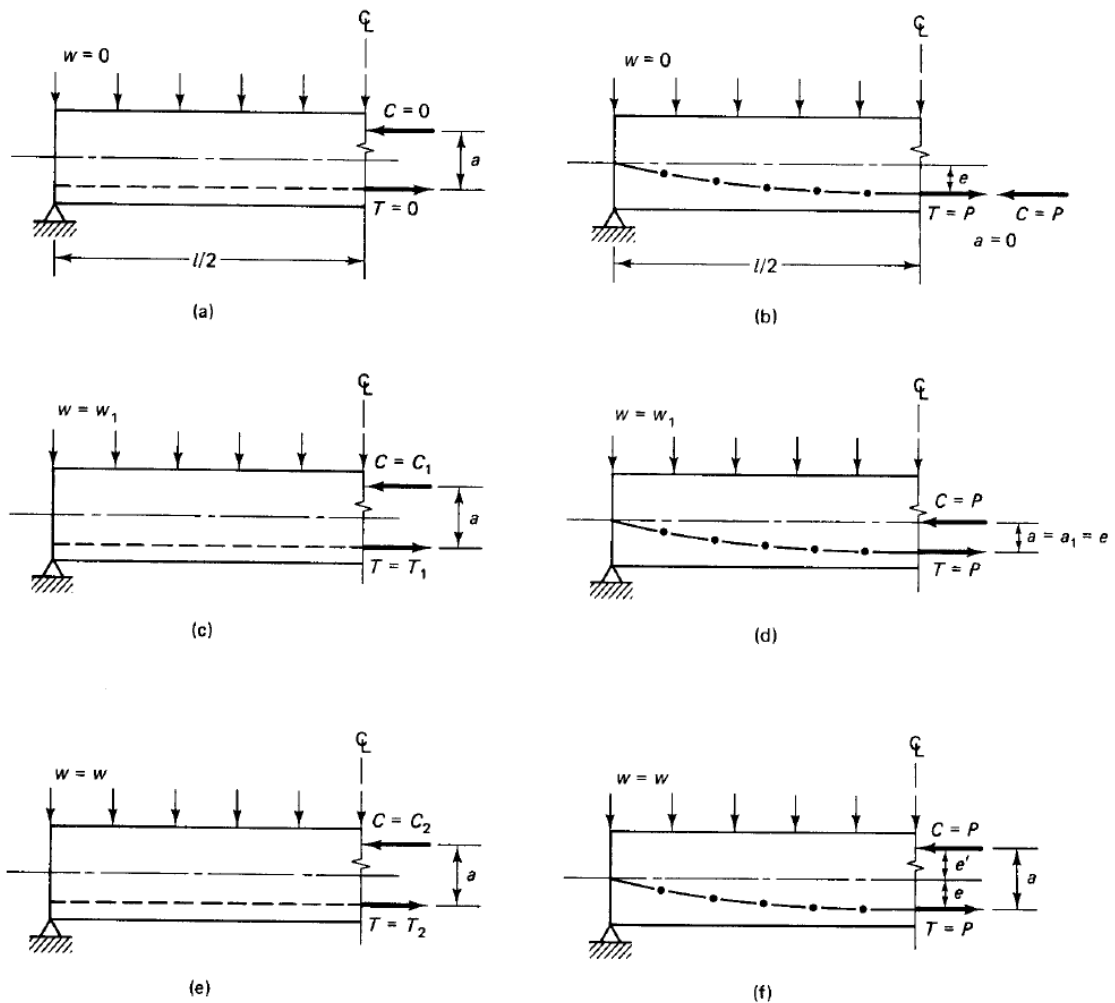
Comparação entre os diagramas de corpo livre de uma viga simplesmente apoiada simplesmente armada e uma viga simplesmente apoiada pré-esforçada; (a) Viga de betão armado sem carregamento; (b) Viga pré-esforçada sem carregamento; (c) Viga de betão armado com um carregamento w_1 ; (d) Viga pré-esforçada com um carregamento w_1 ; (e) Viga de betão armado com um carregamento corrente w ; (f) Viga pré-esforçada com um carregamento corrente w [2].
